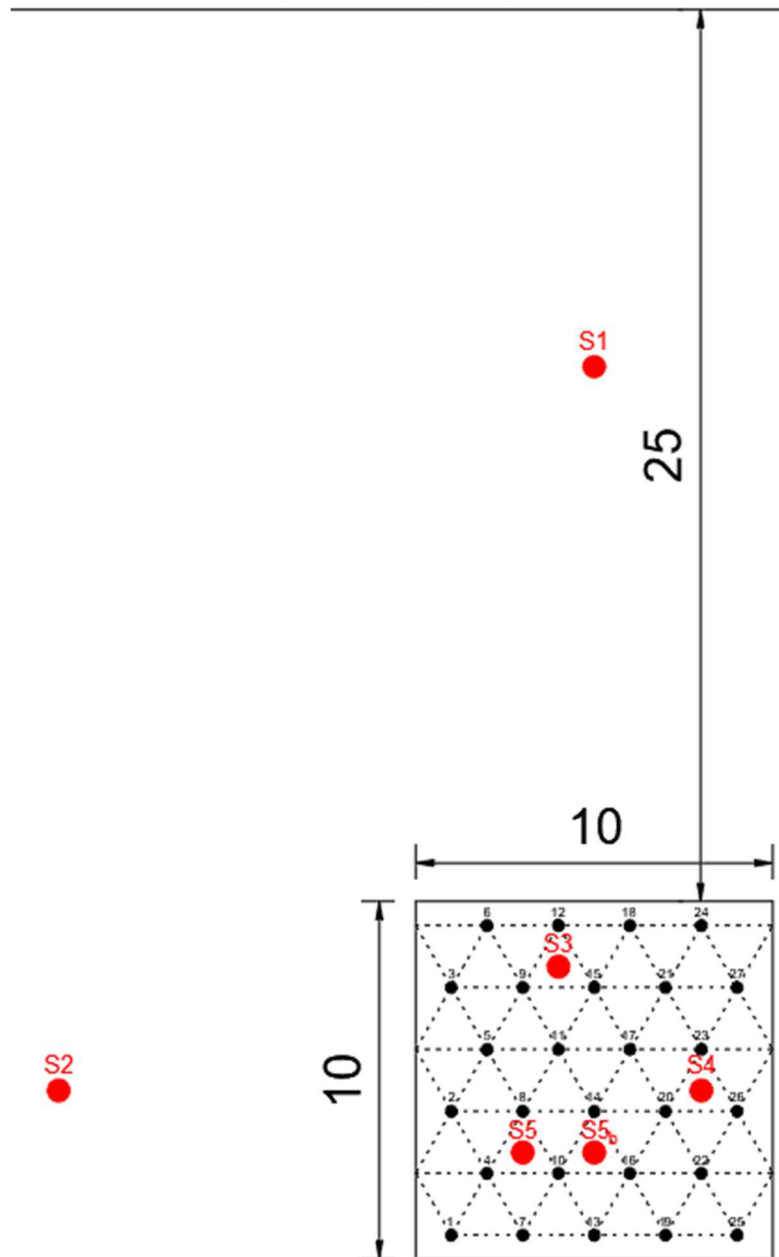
Planimetria punti esecuzione prove geotecniche
